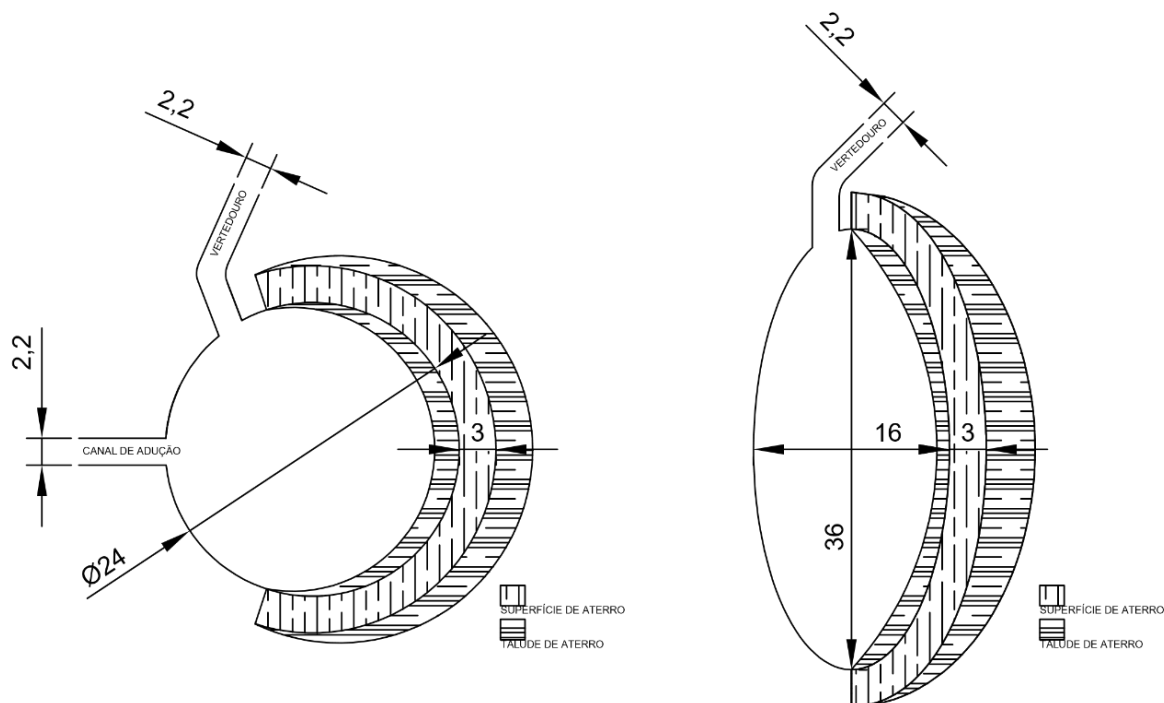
Projeto típico barraginha de 12,0 m de raio interno – vistas superiores – medidas em metros
